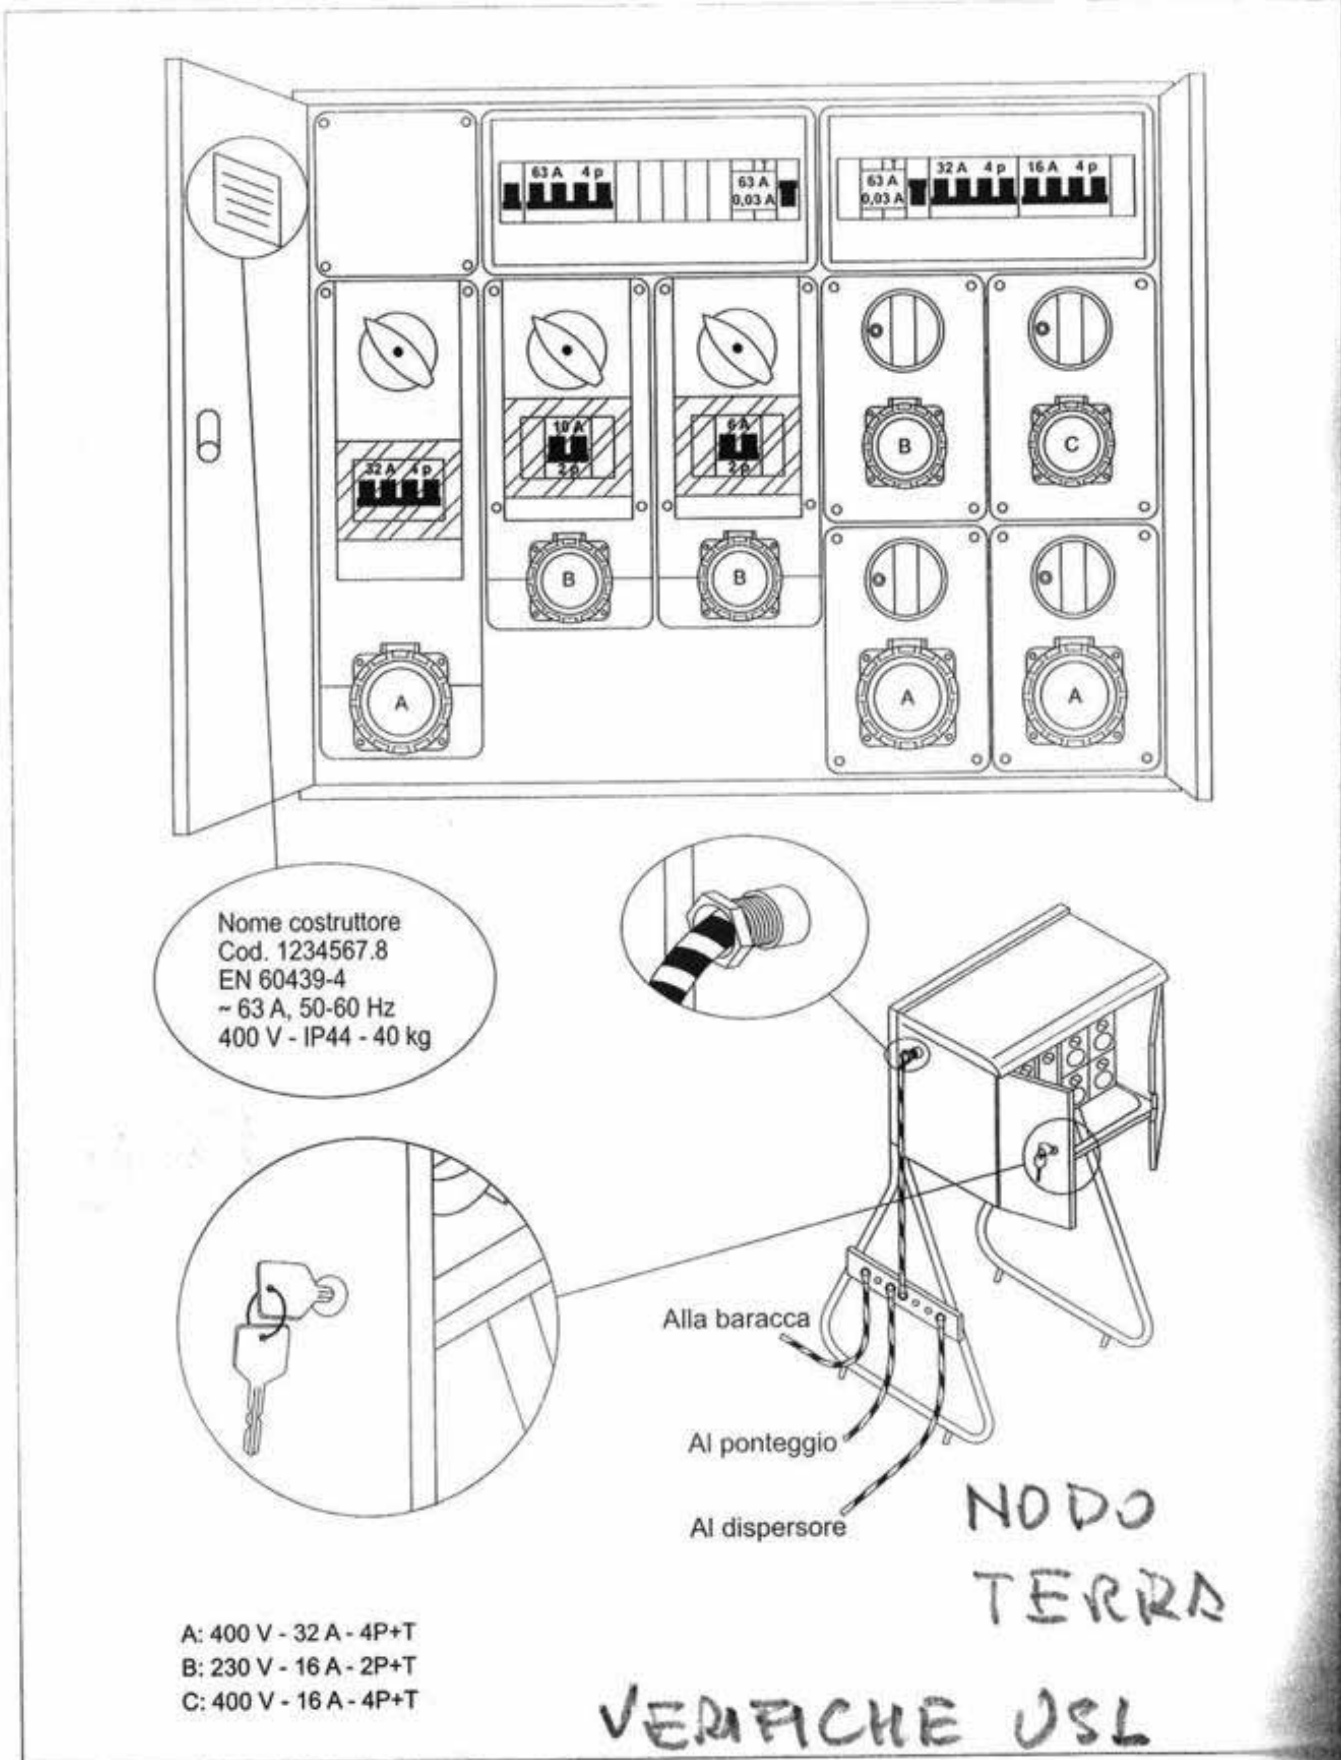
Cantiere medio (25 kW) - Prospetto e sistema di installazione del quadro generale, Q1.
